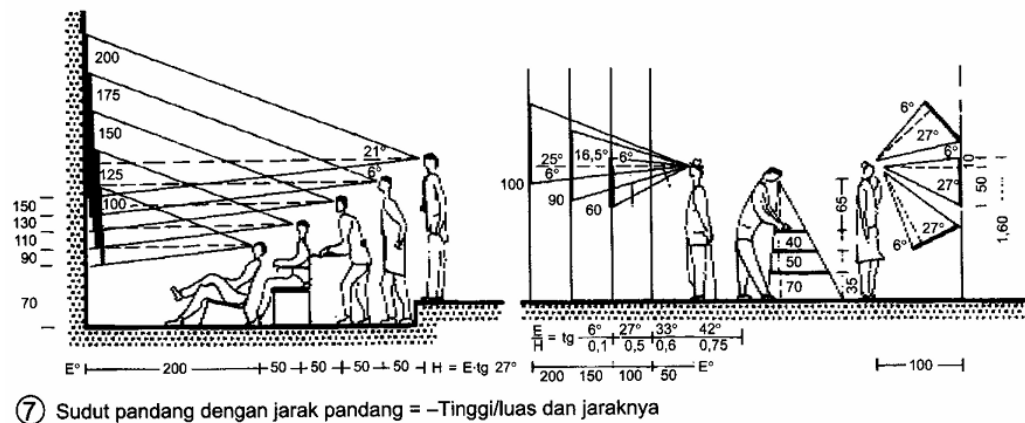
12 Contoh Pencahayaan Ruang Pamer
